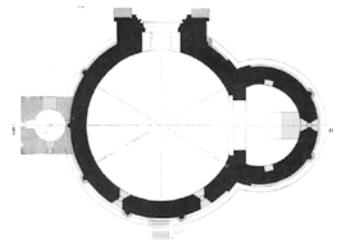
Grundriss MdkkCC 1867, 132. M 1:400.
